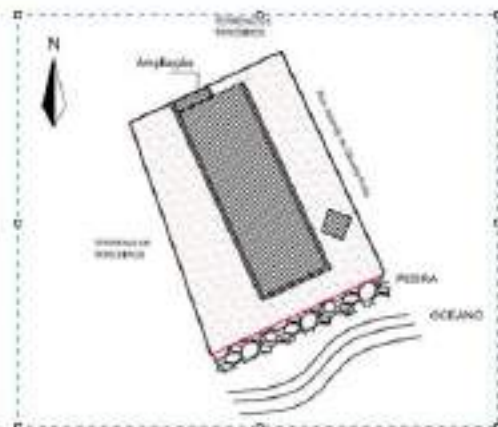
Vista das fachadas a situação do imóvel em 2015.
